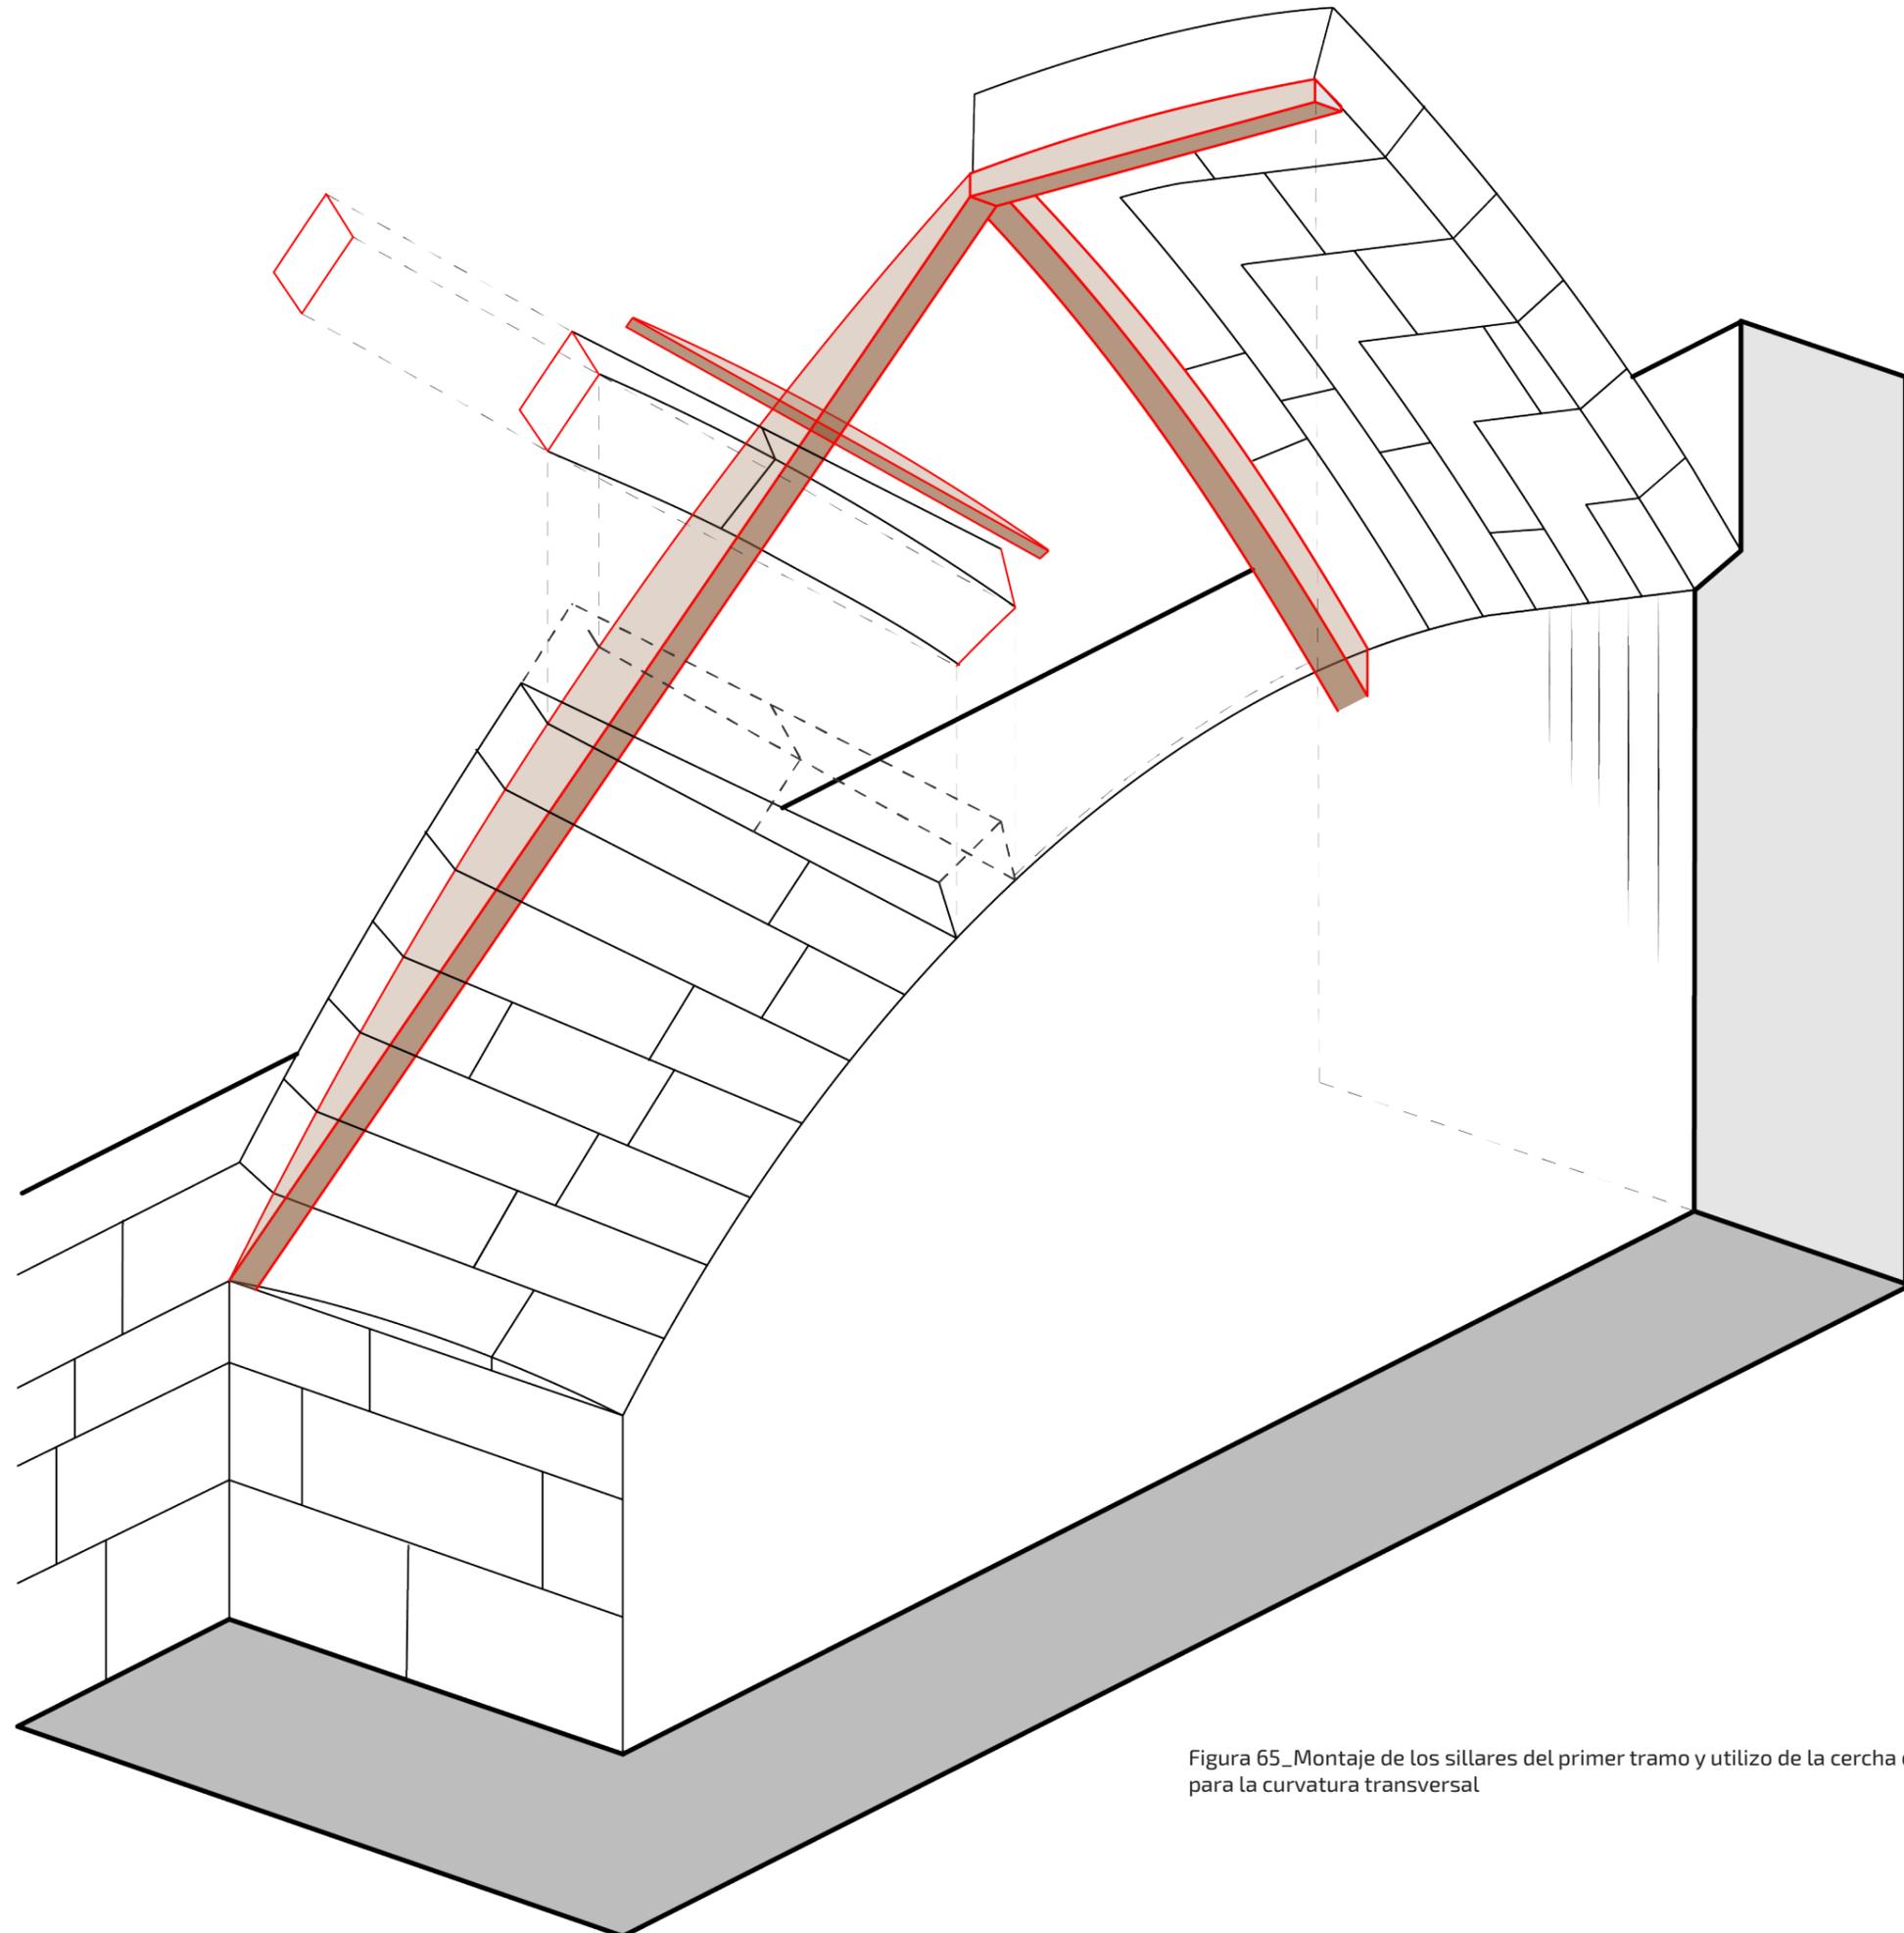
Montaje de los sillares del primer tramo y utilizo de la cercha de madera para la curvatura transversal
